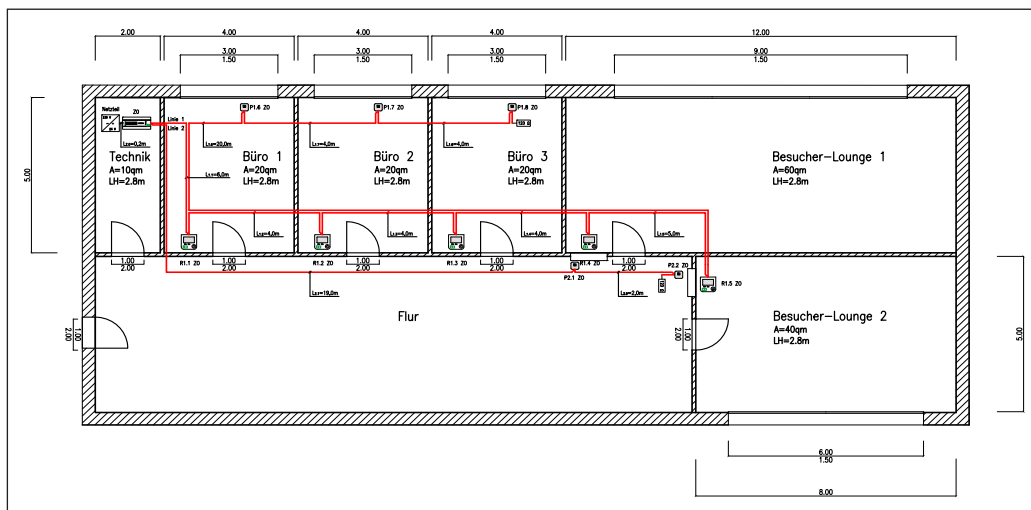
Grundriss des Bürogebäudes (Elektro-, Mess- und Regelungstechnik).
